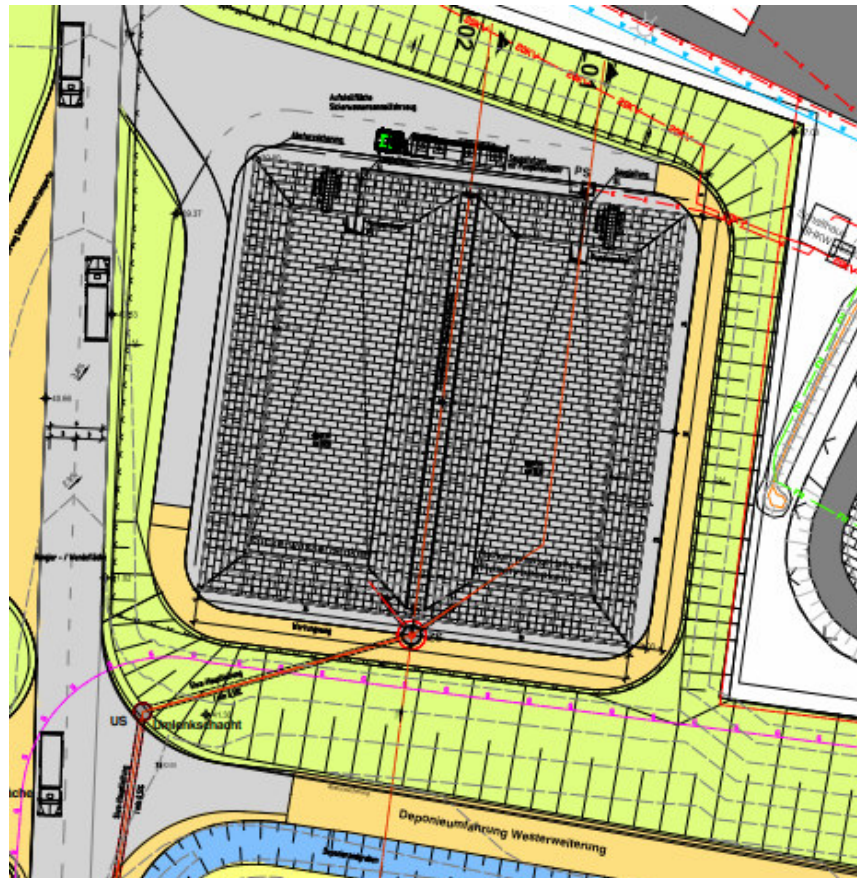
Teillageplan Sickerwassersammelbecken
